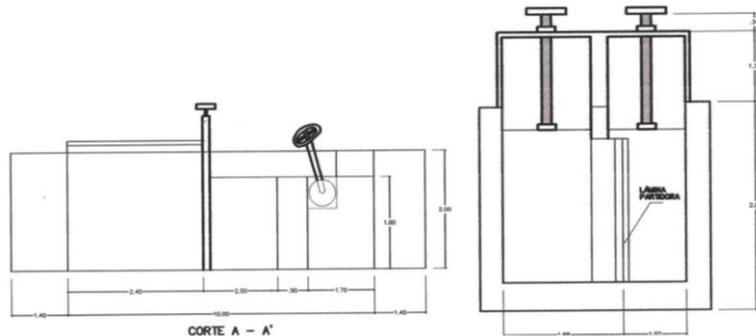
Detalles de la obra de captación, vistas en corte longitudinal y detalles de compuertas.
